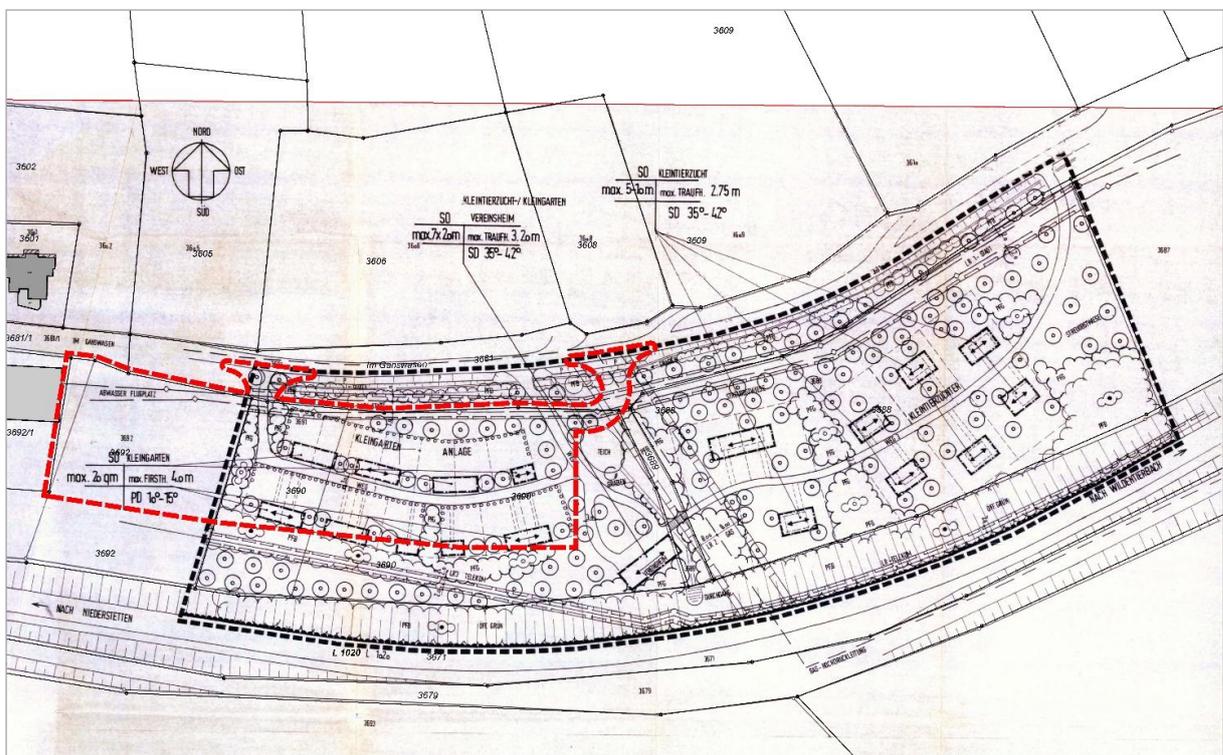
Vorliegender Bebauungsplan "Kleintierzucht- und Kleingartenanlage" (Ausschnitt o. M.)
